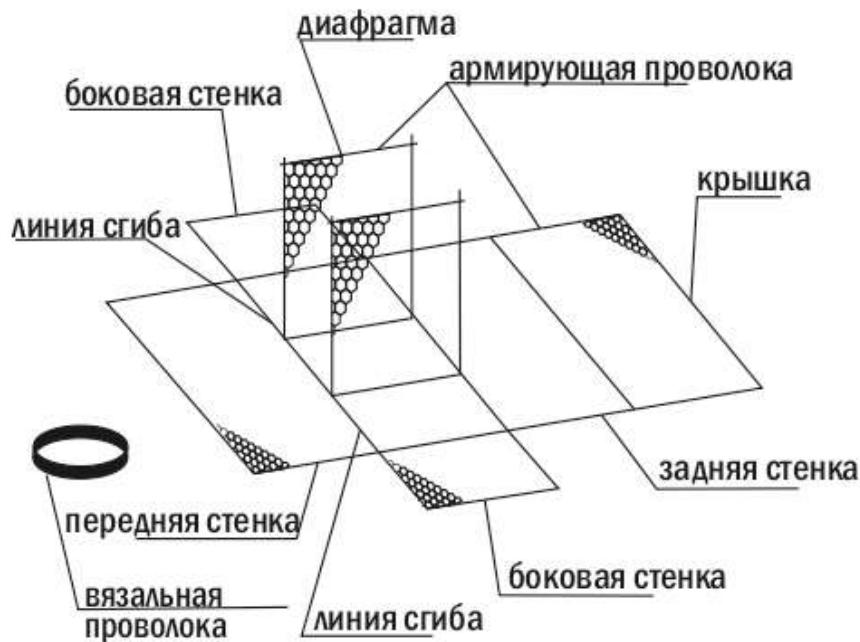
Развёртка коробчатой габионной конструкции
